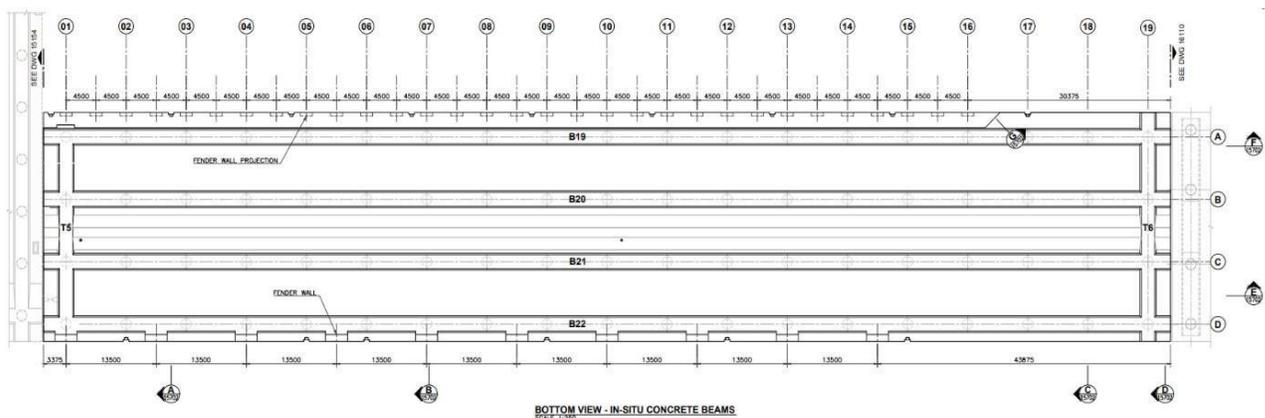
Plano general de vigas Q3/Q4. Fuente: Cotema
